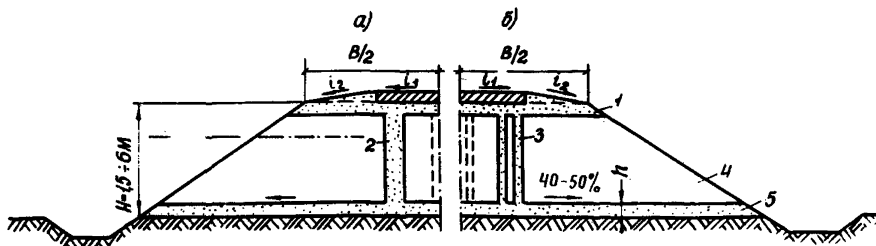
Схема конструкции земляного полотна с вертикальными песчаными дренами в виде сплошного цилиндра (а) и цилиндрической трубы (б): 1-верхний дренирующий слой; 2-песчаная дрена; 3-дрена с кольцевым сечением; 4-грунт земляного полотна; 5-нижний дренирующий слой;  $l_1 = 20\%$ ;  $l_2 = 40\%$
